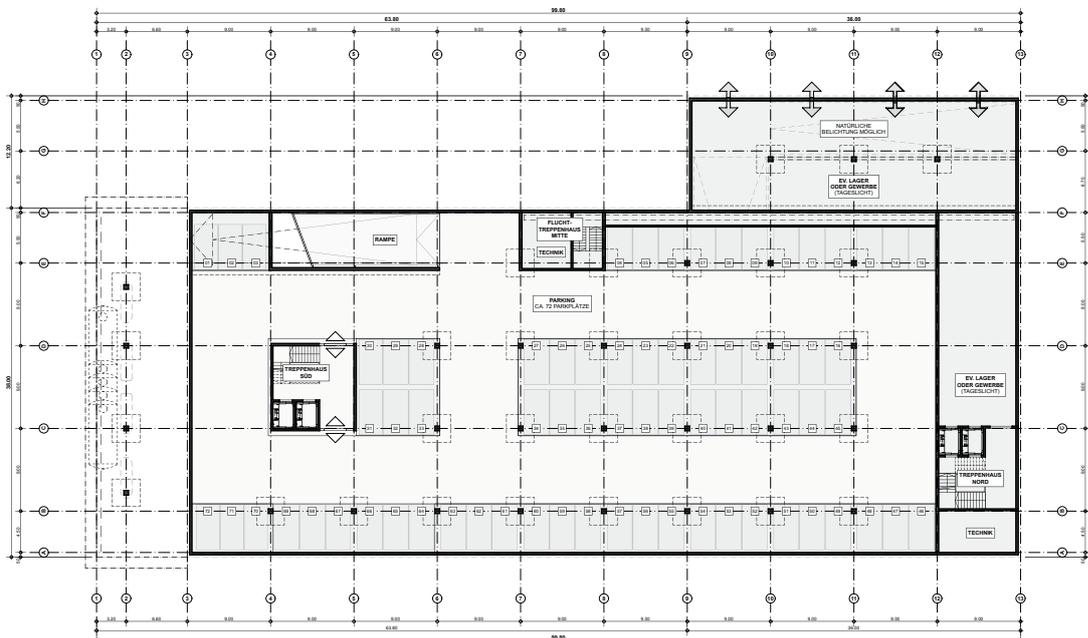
Grundriss Untergeschoss, Richtprojekt Dezember 2024
